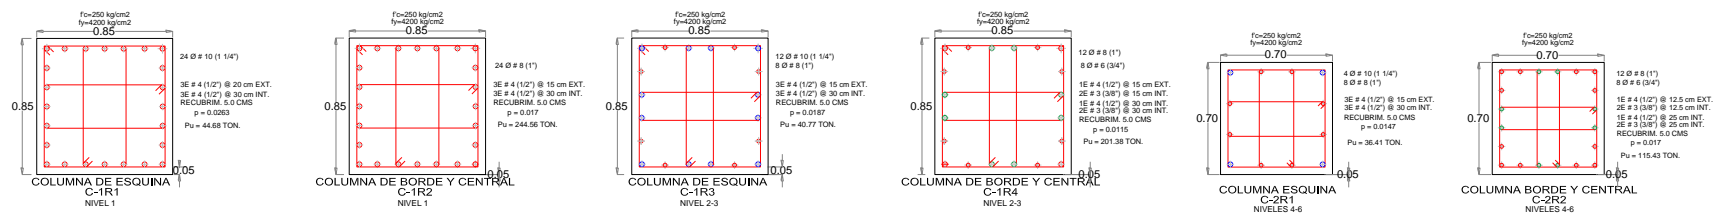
Detallado de armado de columnas de edificio de 6 niveles con base a la hipótesis de las NTCC-17.
